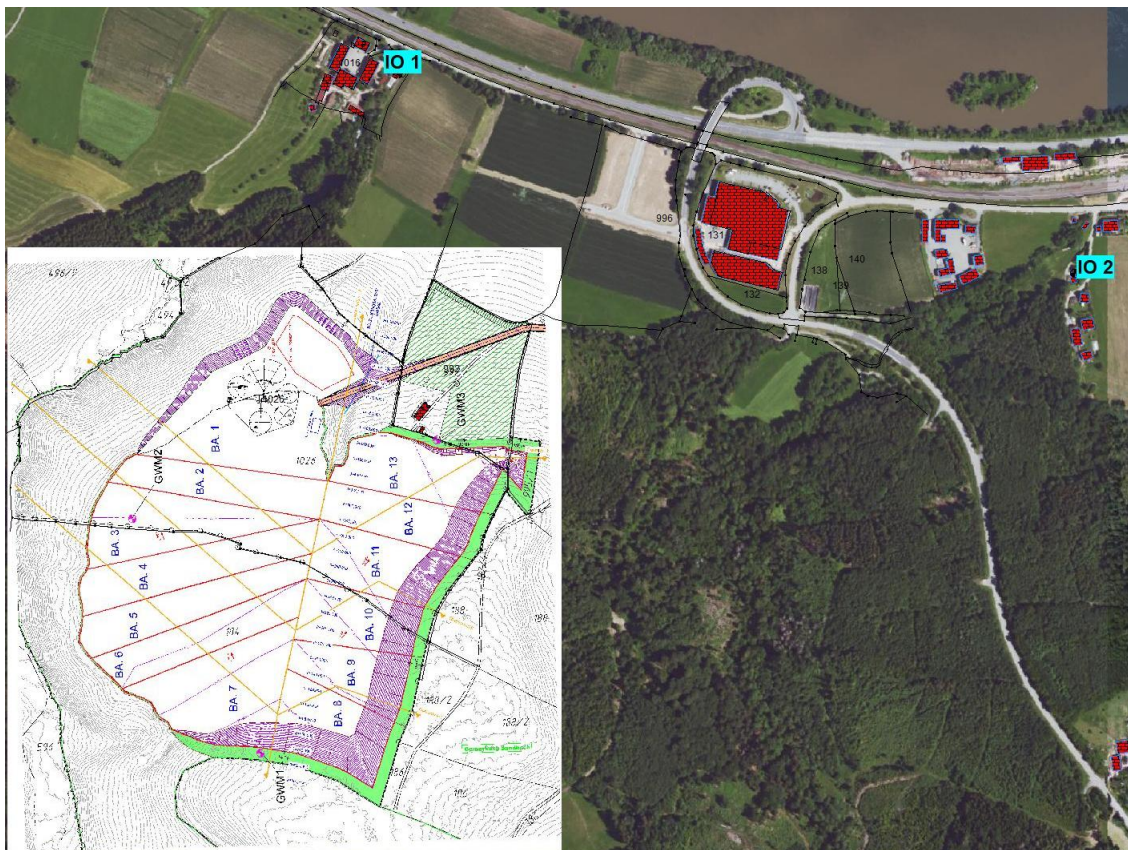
Lageplan mit Kennzeichnung Immissionsorte IO 1 – IO 2
